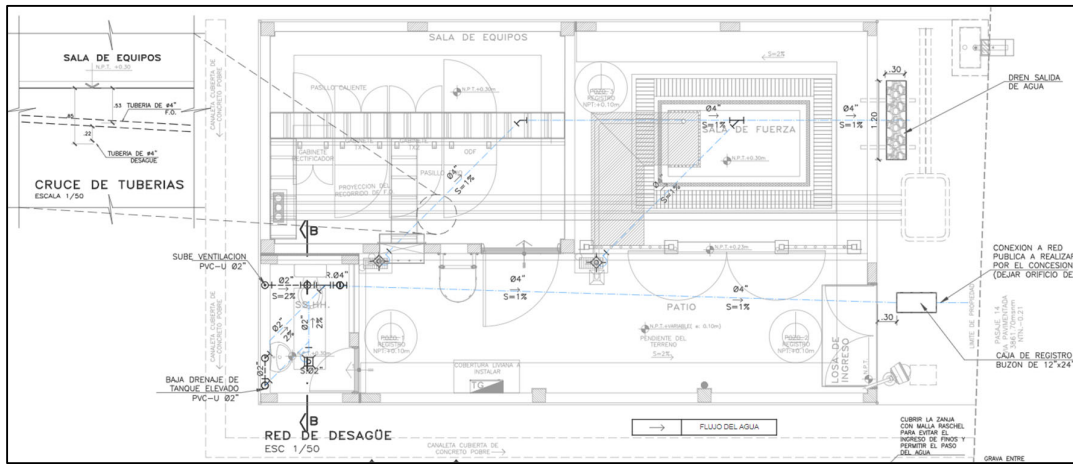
Plano de Planta de Red de Desagüe (IS-02)
